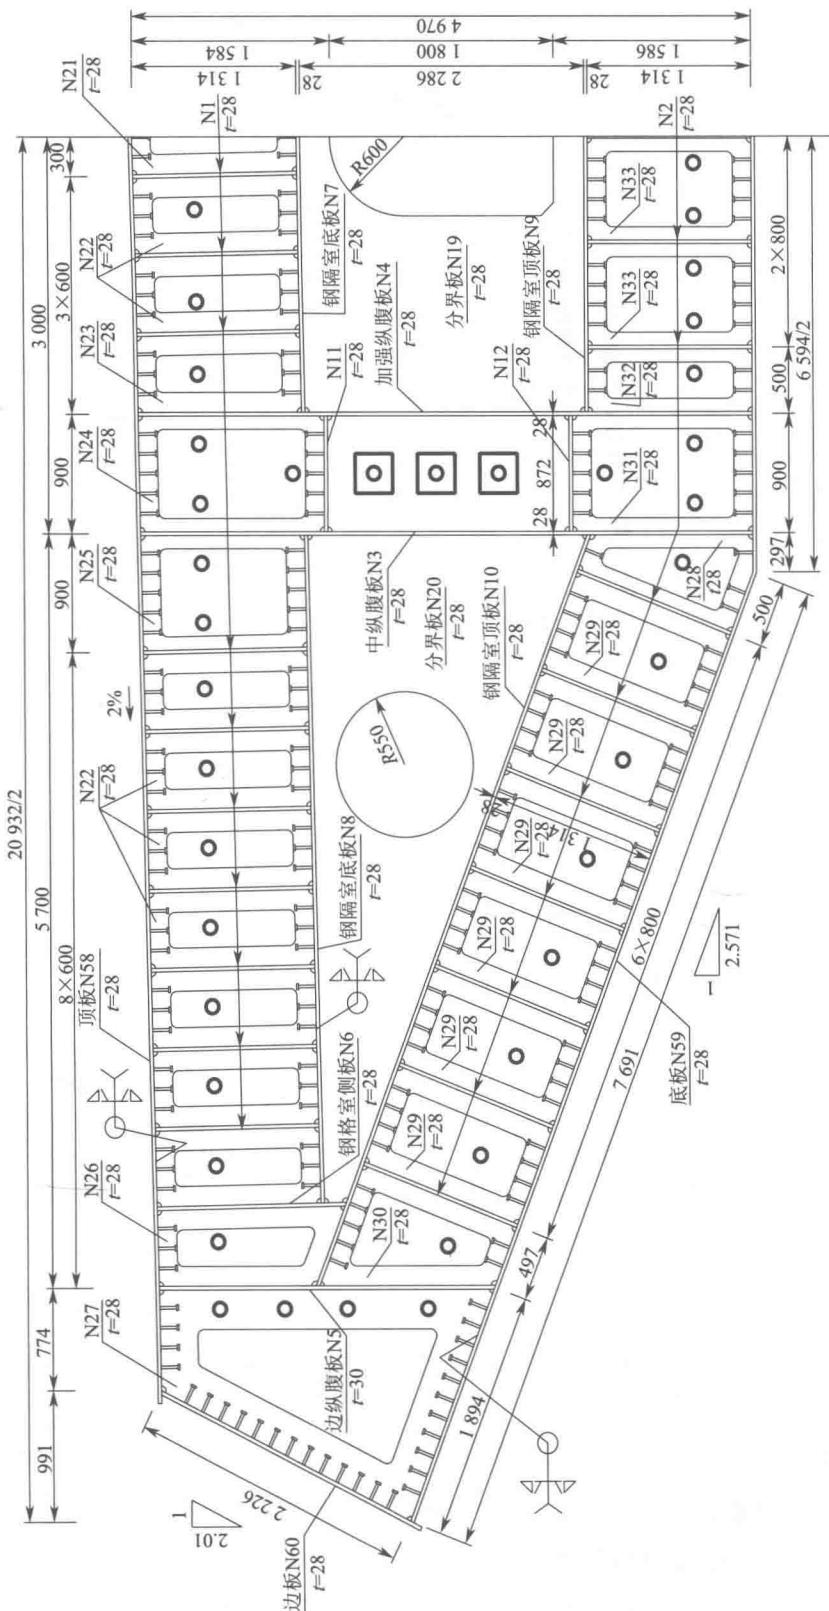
钢—混结合段 1/2 截面图(单位:cm)
